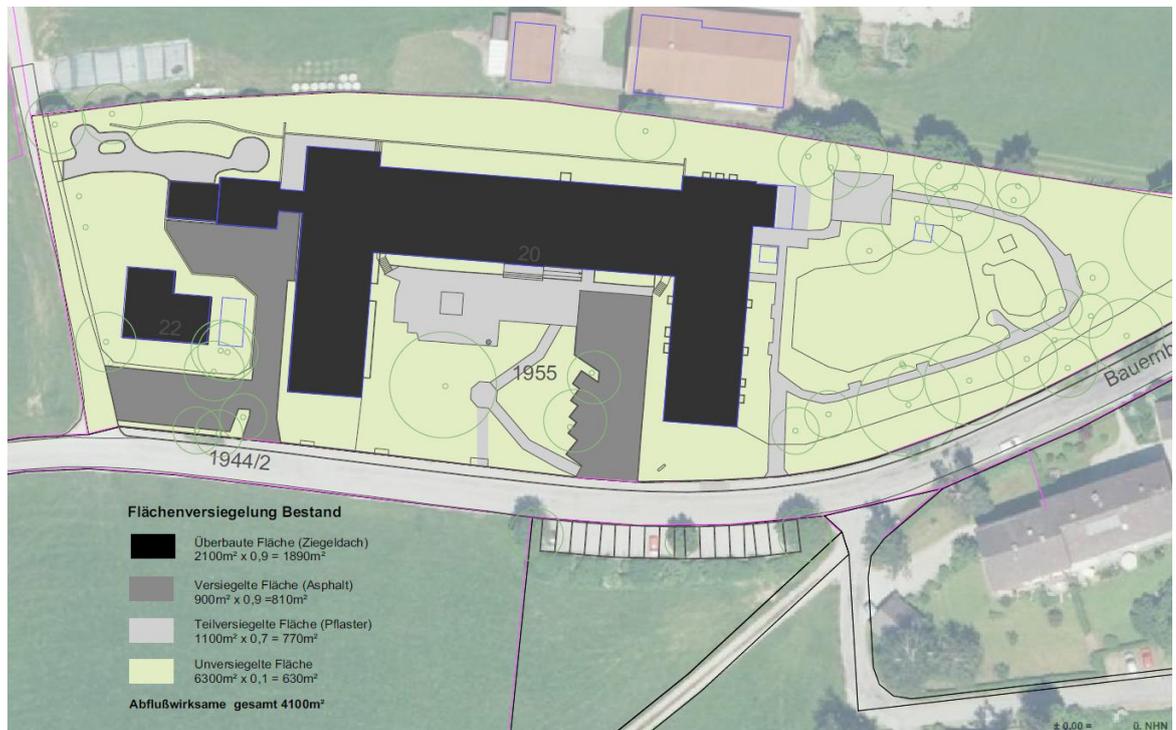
Ermittlung abflusswirksamer Flächen Bestand – ohne Maßstab (Quelle: SchelleHeyseBehr Landschaftsarchitekten)
